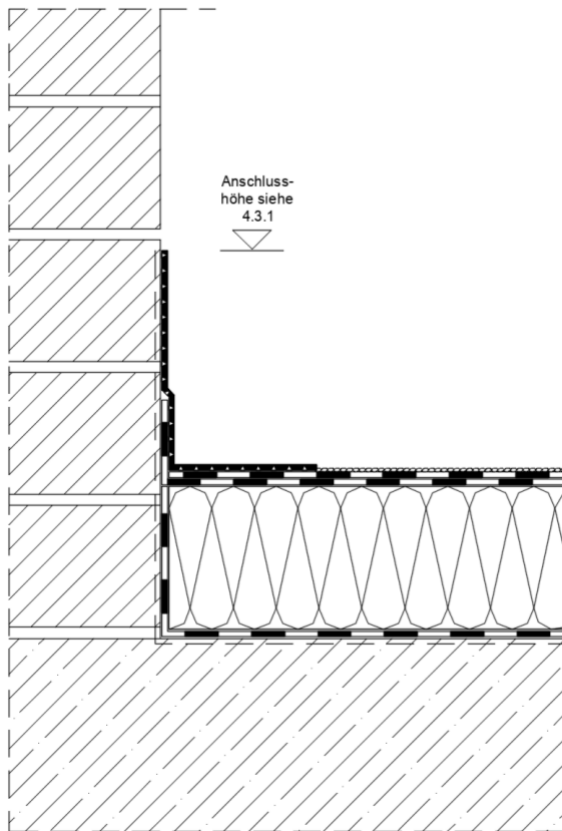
Beweglicher Anschluss mit Bitumenbahnen – ungedämmte Wand
